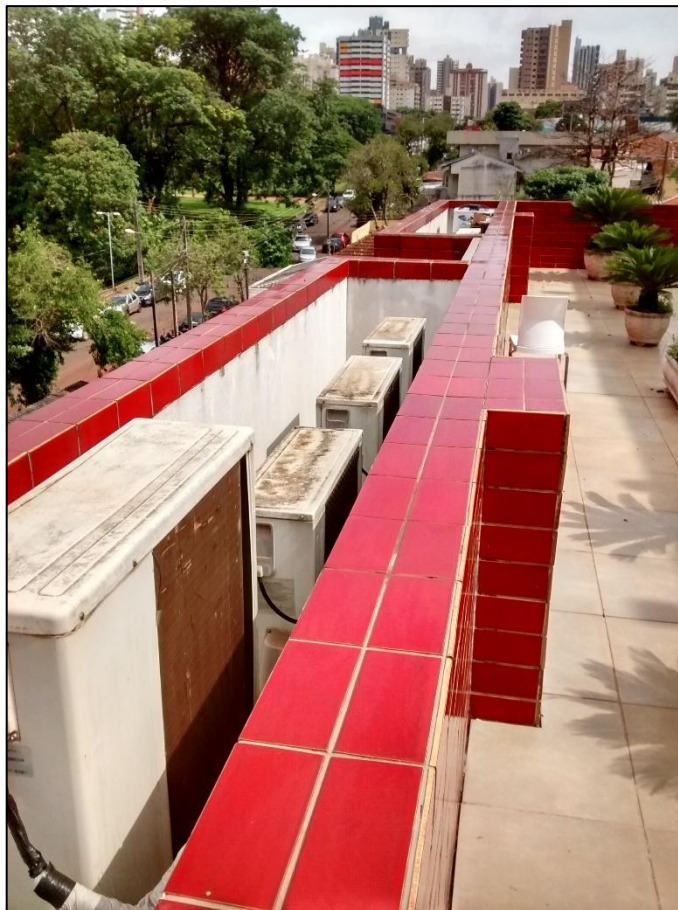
Localização das máquinas de ar condicionado no terceiro pavimento.
